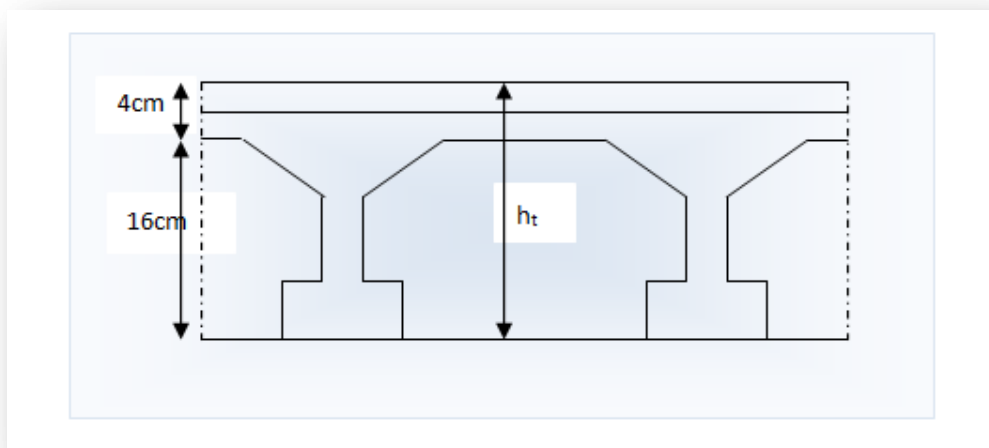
Coupe transversale d'un plancher à corps creux
